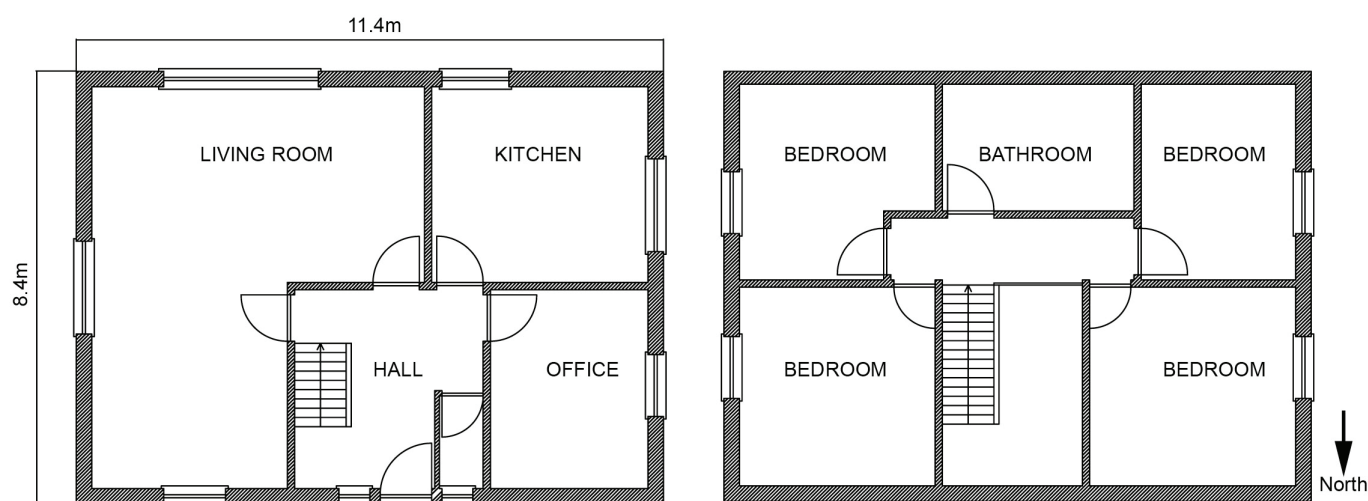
Plan du rez-de-chaussée et de l'étage de la maison de référence
